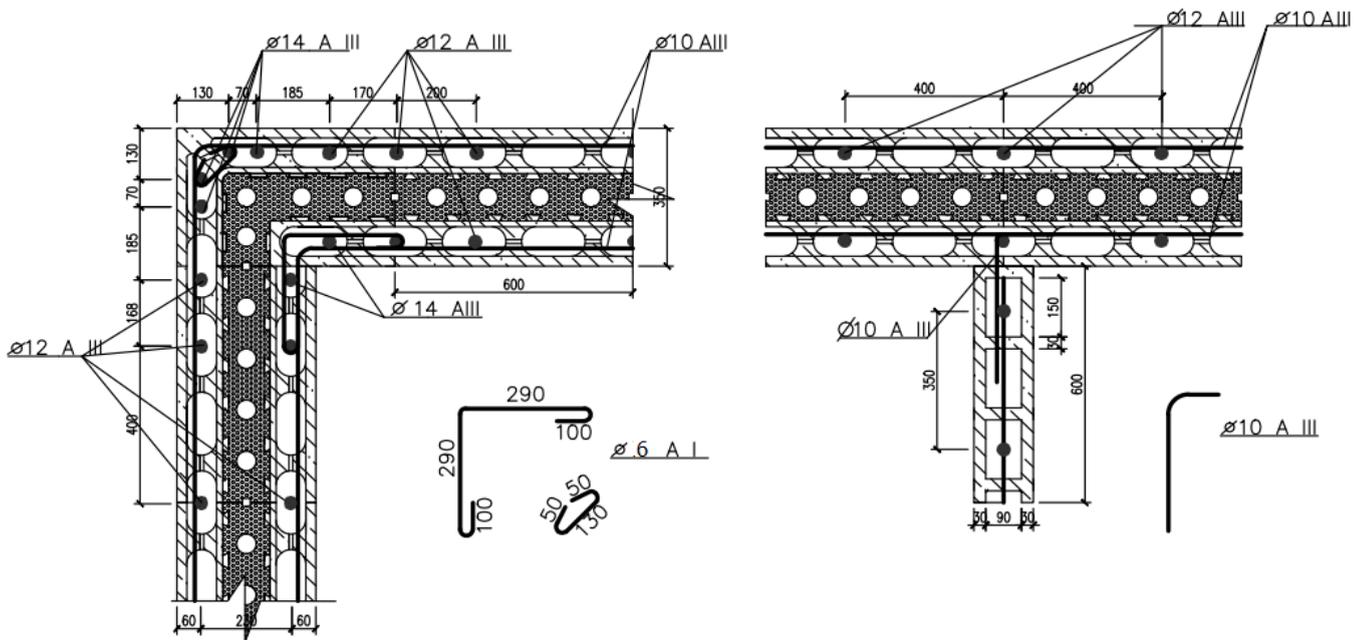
Схема узлов и армирования межкомнатных перегородок и ограждающих стен
